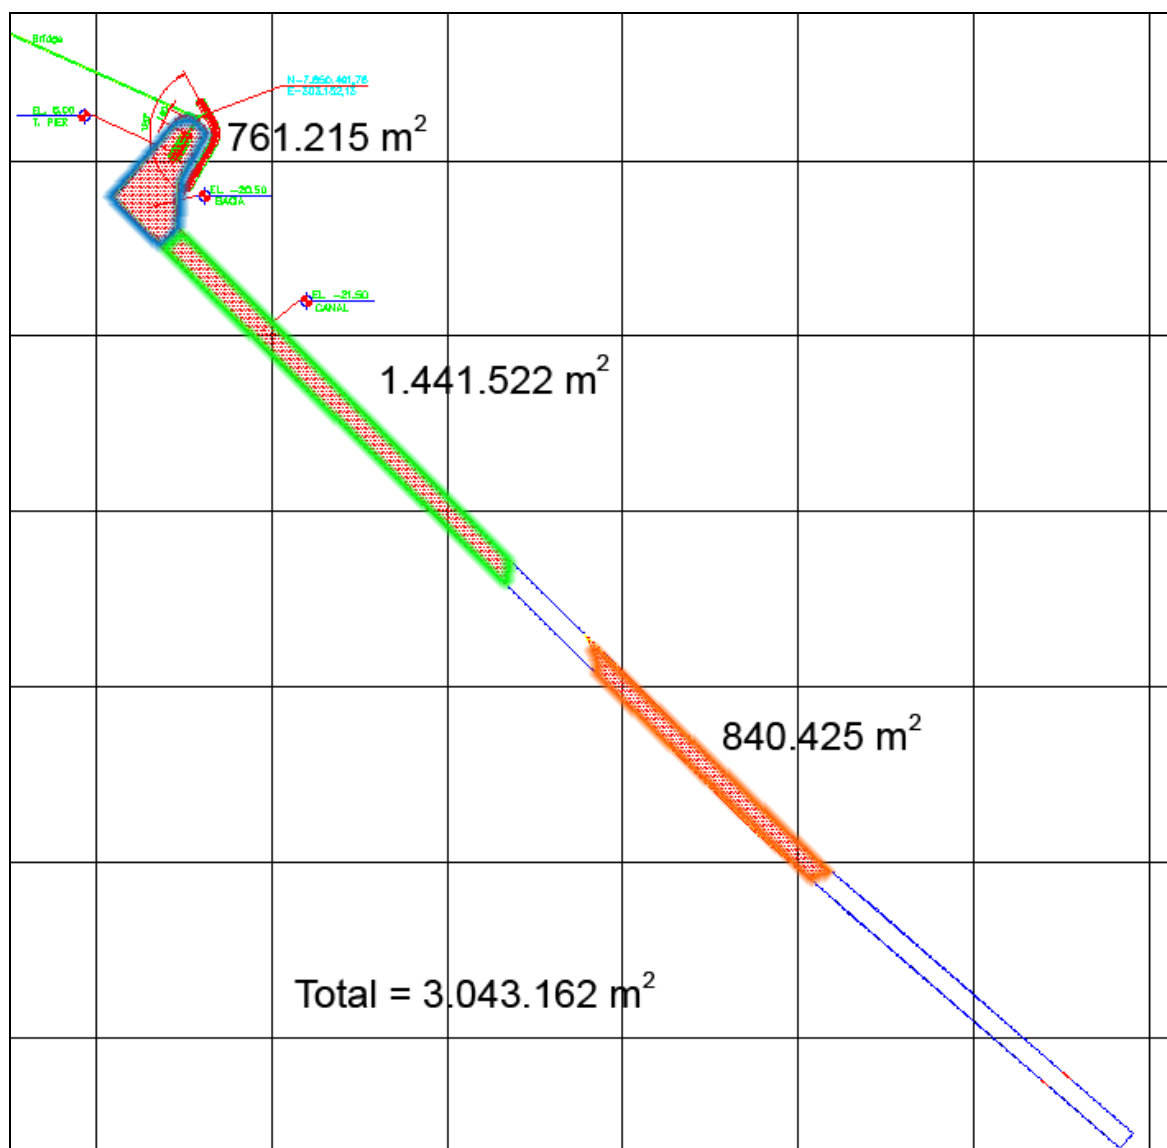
Dimensão em planta das áreas do terminal a serem aprofundadas.
